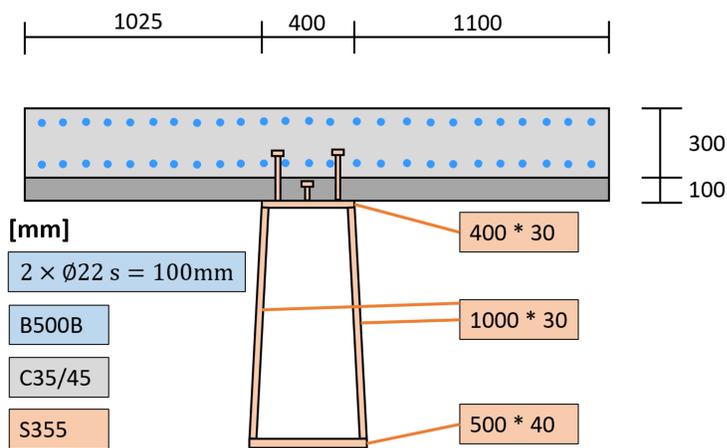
Nachweisequerschnitt für Längsträger mit dazugehörigem mitwirkendem Betondruckgurt
